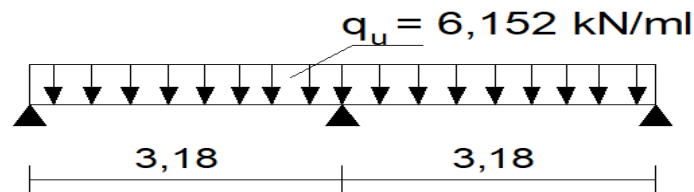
Schéma statique de la poutre continue reposant sur 3 appuis.
